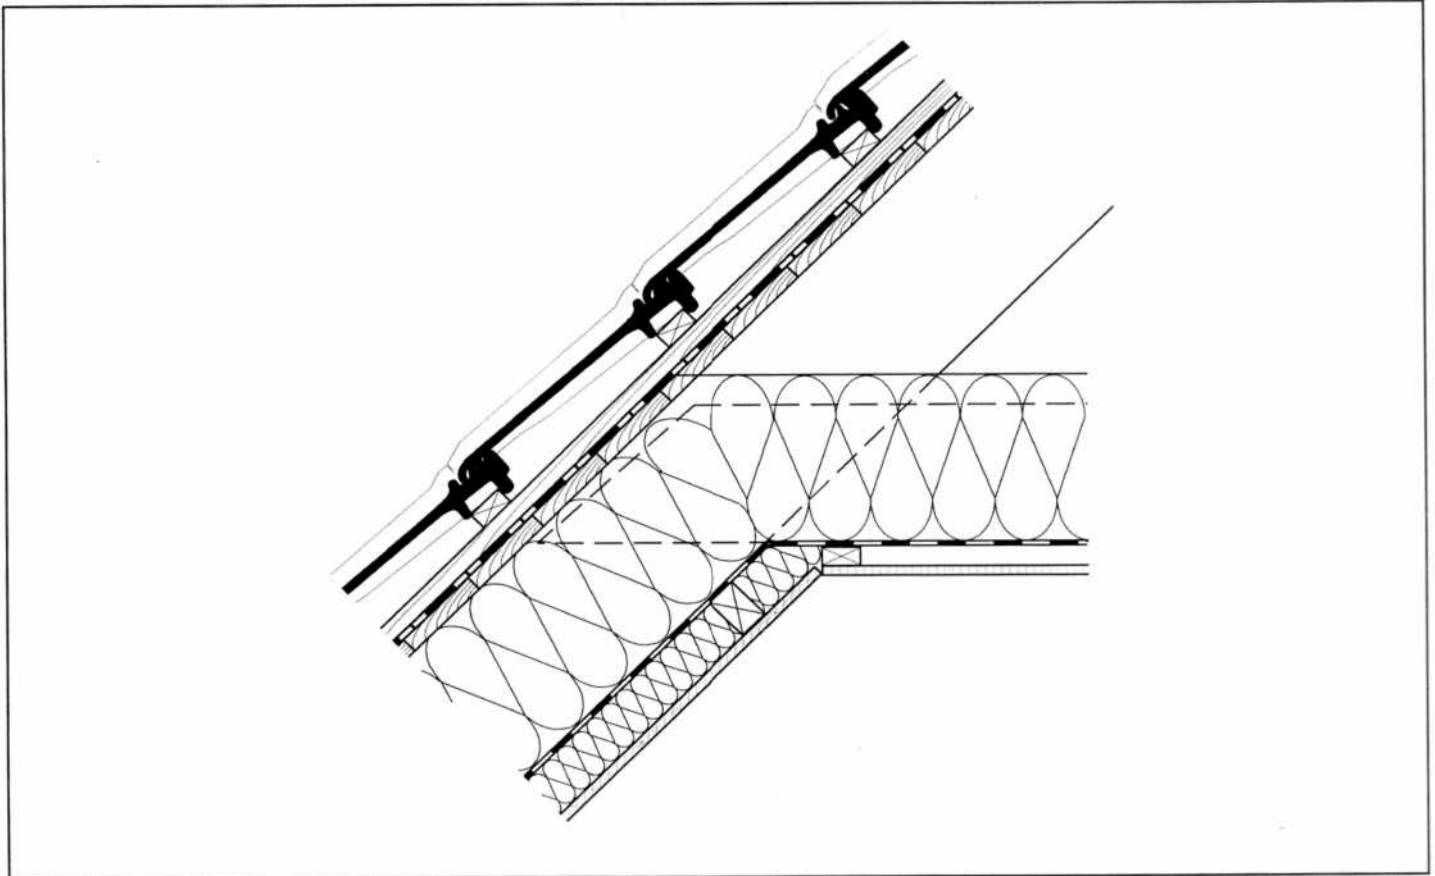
Detailausbildung im Bereich der Mittelpfette für die Dachkonstruktion D 4.
